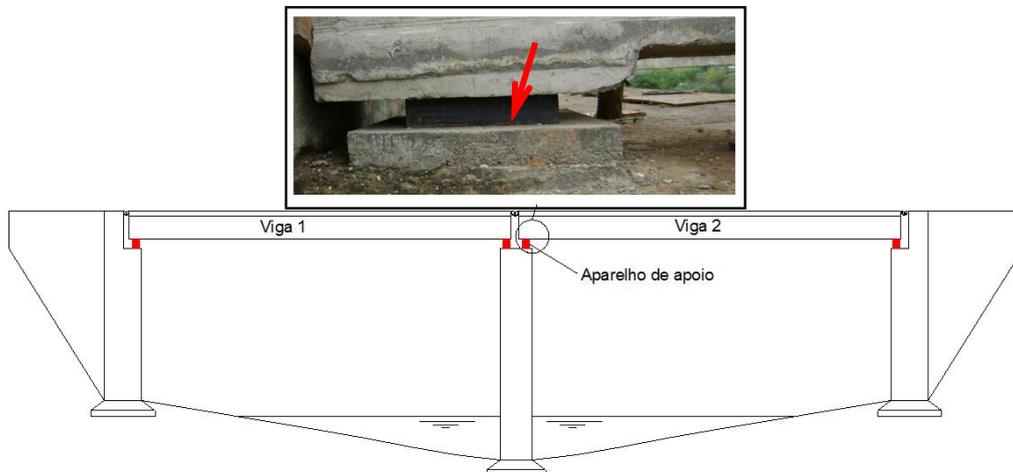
Vista longitudinal de ponte com 2 tramos isostáticos - Detalhe da região do aparelho de apoio de elastômero
